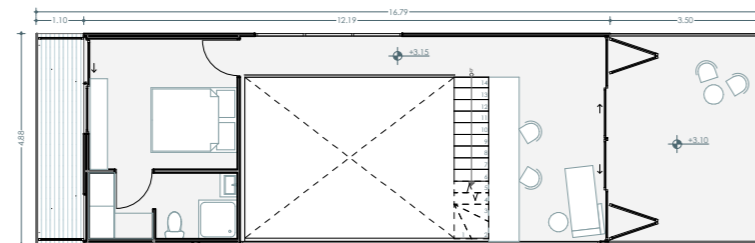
Planta alta Casa Huiini. Fuente: Autores, 2023
